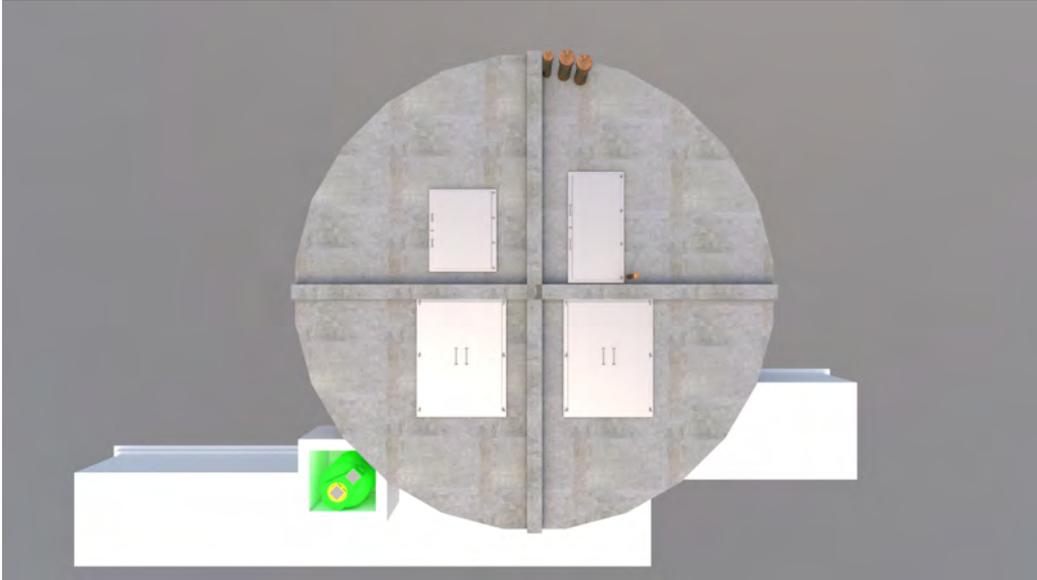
Vista in pianta del locale centrale e delle botole metalliche poste sul solaio di copertura.
